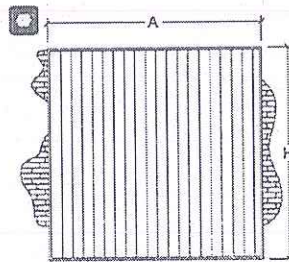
Detalle de alzado de puerta industrial corredera apoyada
